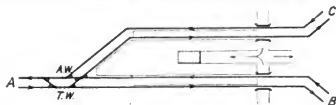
Kopfbahnhof mit Abstellbahnhof.
